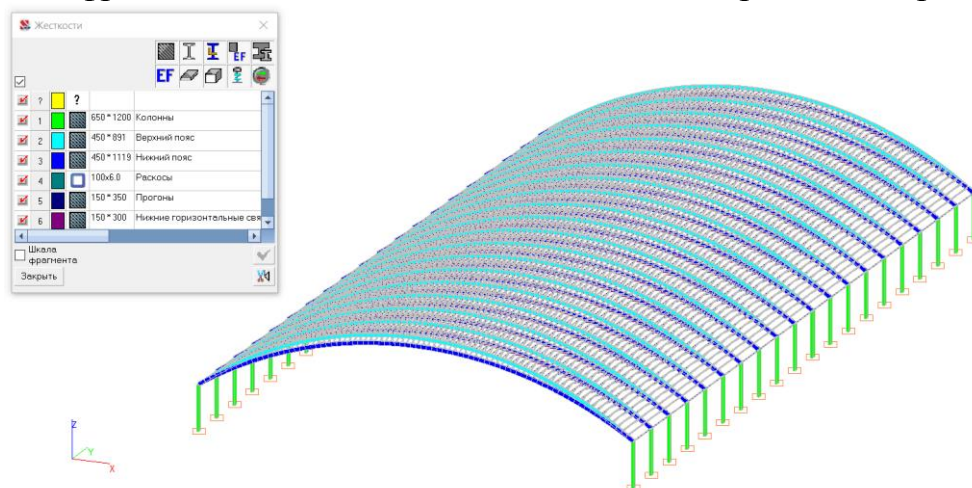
Общий вид расчетной схемы покрытия
